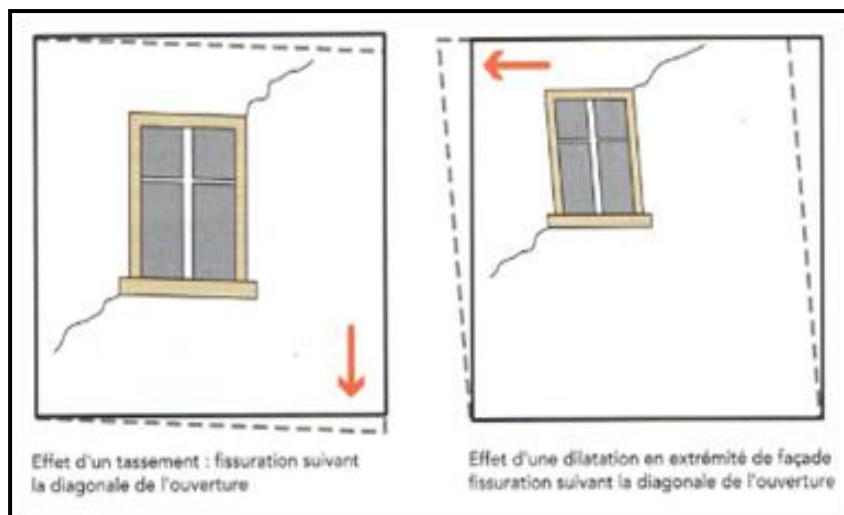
Les fissures se forment dans l'angle des ouvertures.
